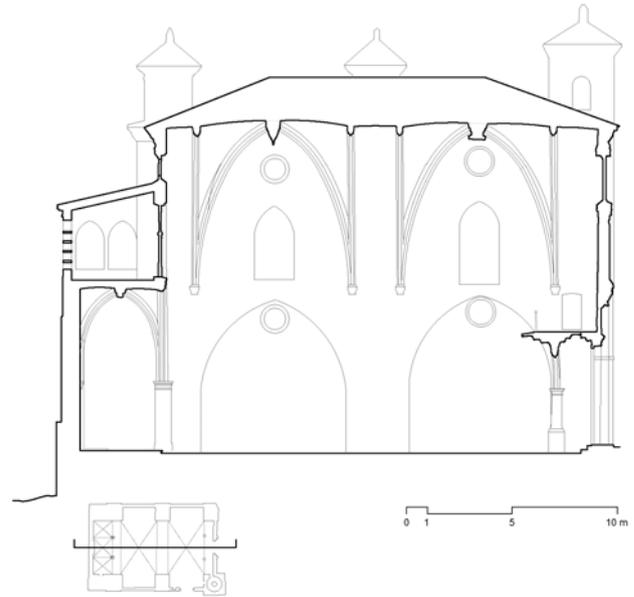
Plano de la sección longitudinal obtenido del modelo digital. Elaboración propia.
